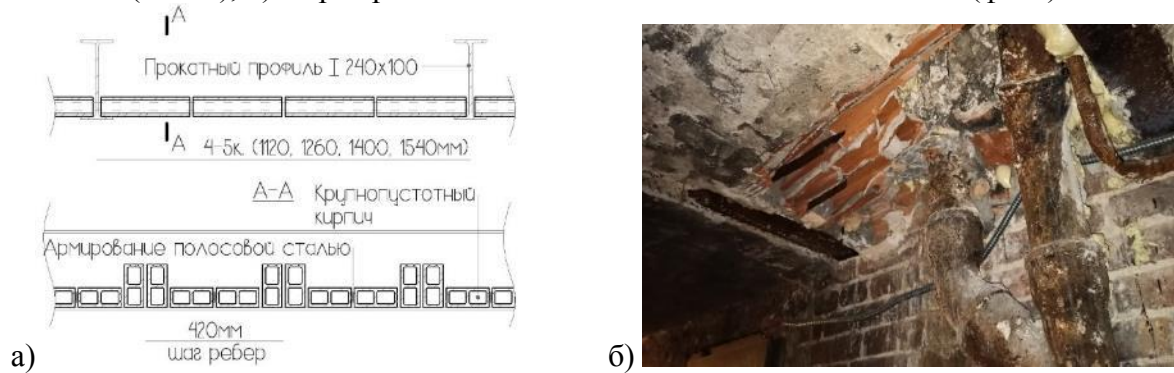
а) – несущая конструкция междуэтажного перекрытия Клейна, пролет до 6 м (схема), б) – надподвальное перекрытие, тип 1 (фото)
